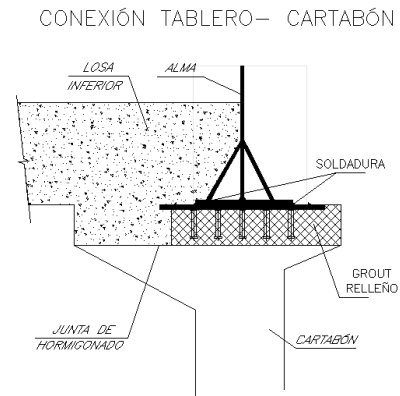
Detalle de unión bijácena metálica-cartabón de hormigón.
